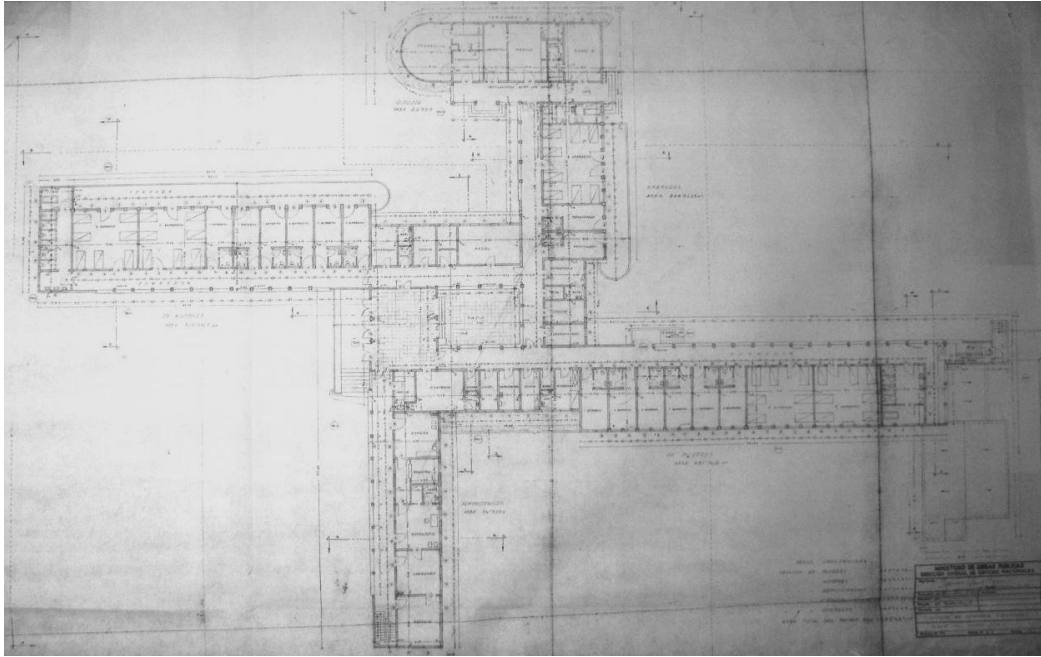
Zweites Projekt des Krankenhauses von Concordia. Grundriss des Erdgeschosses.
